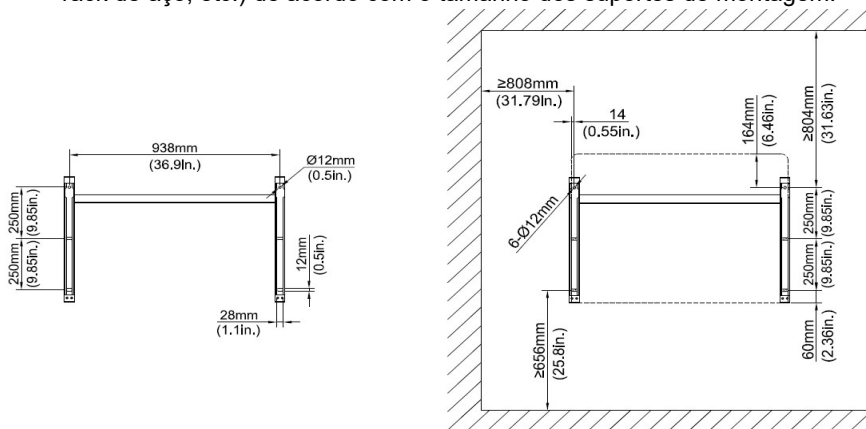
Dimensões da posição do furo do suporte de montagem único
